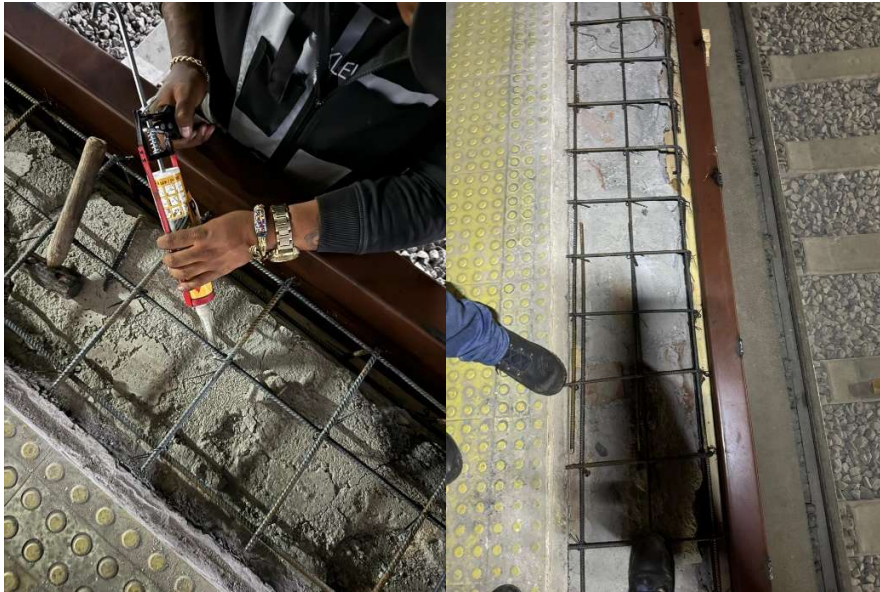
Anclaje de Varilla a Firme de Concreto Existente. Elaborado por el autor.
